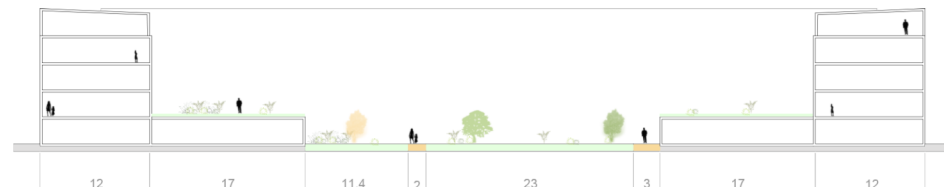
2. Sección de manzana con cubiertas verdes.
